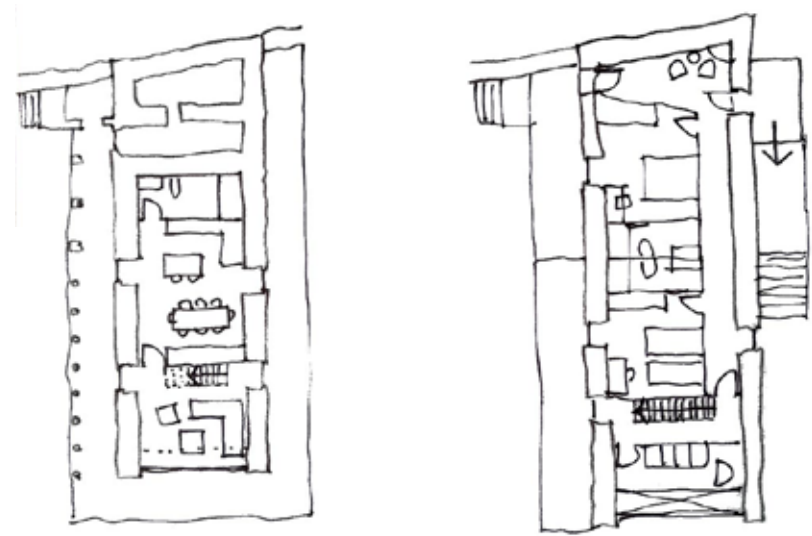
Segunda distribución de planta baja y planta alta (Elaboración propia)
